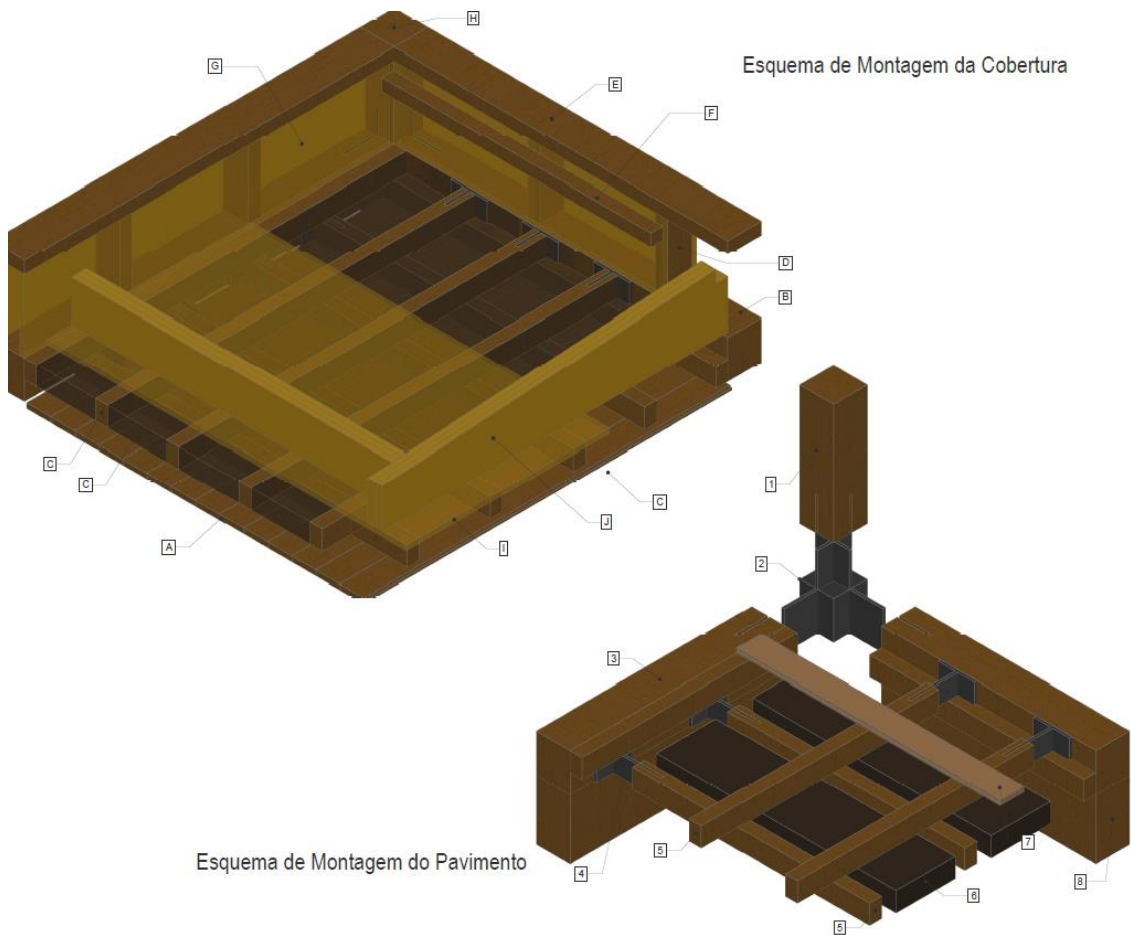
Esquema estrutural de montagem da cobertura e do pavimento
